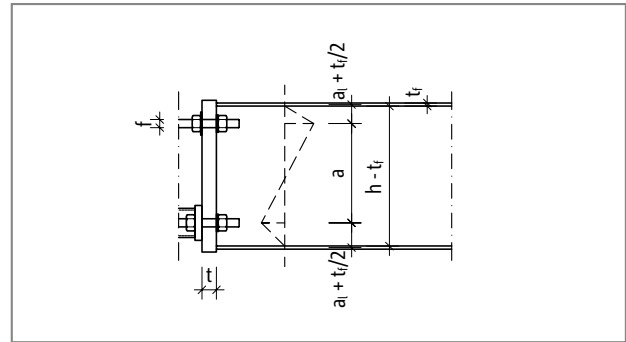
Plaque frontale affleurante T type S : calcul des entrées géométriques ; coupe
